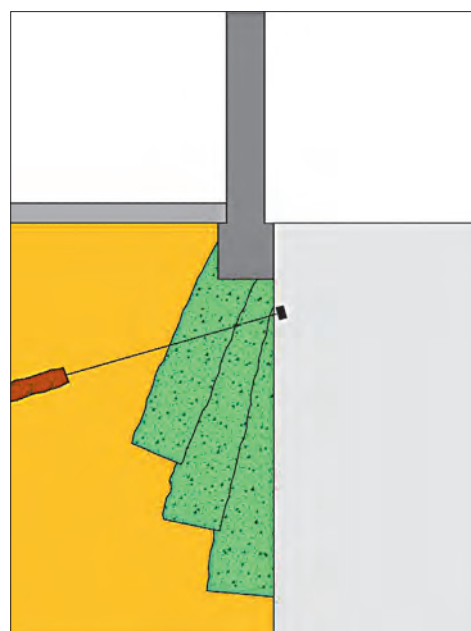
RECALCE CON JET-GROUTING RECORTADO Y ANCLADO PARA EXCAVACIÓN MEDIANERA.
